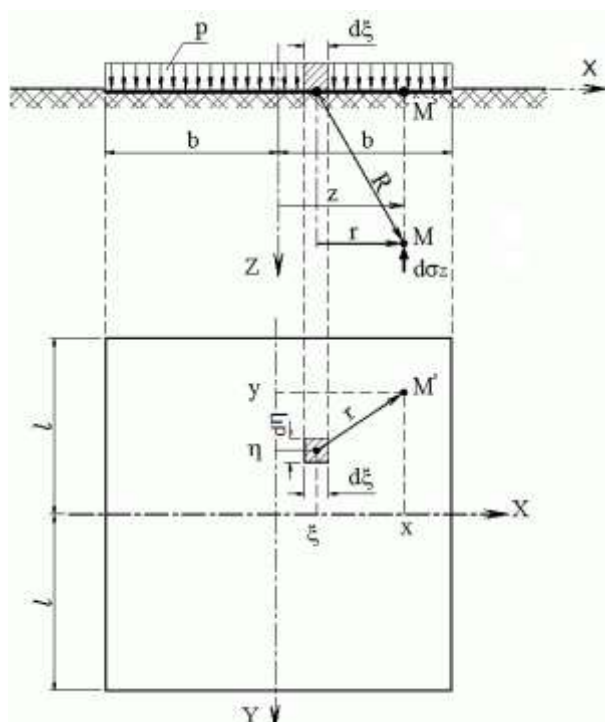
Расчётная схема для определения напряжений от нагрузки, распределенной по прямоугольнику; P – интенсивность нагрузки; l, b – полудлина и полуширина площади нагрузки (подошвы фундамента)
